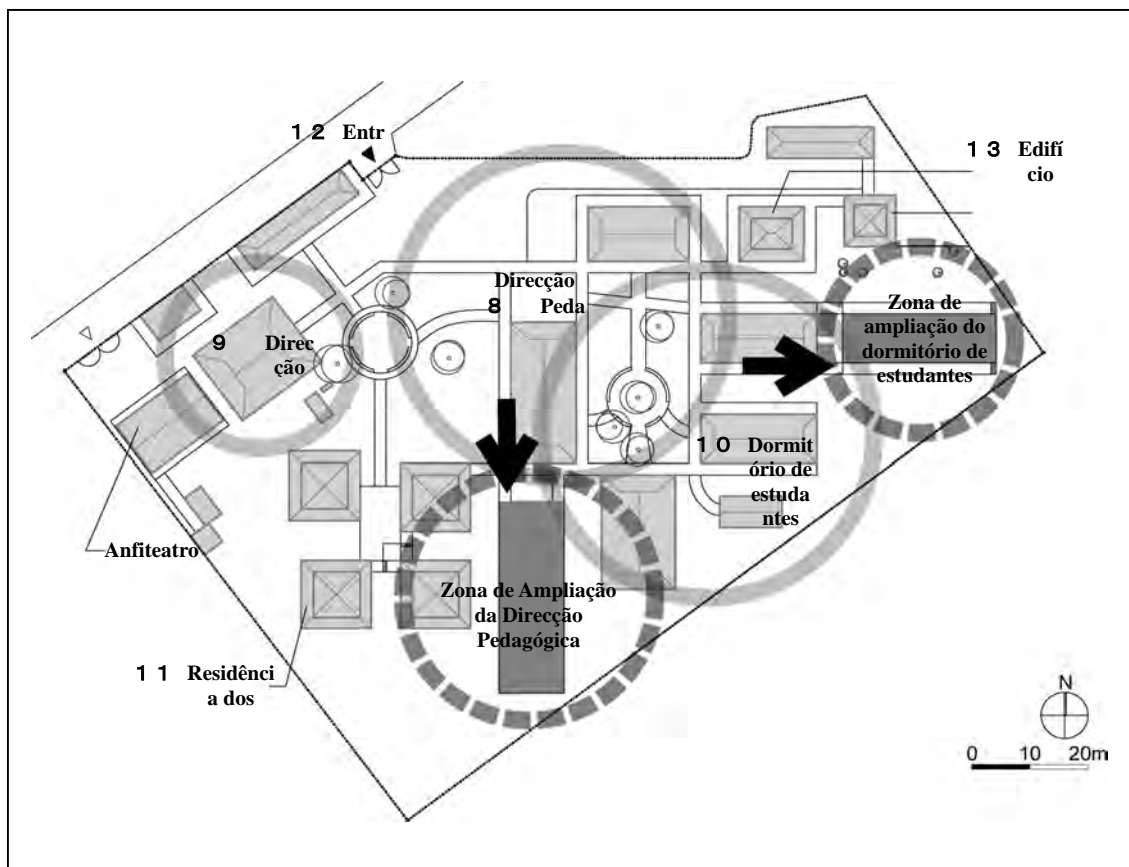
Plano de estudo do terreno e da disposição das instalações do CFS Pemba
